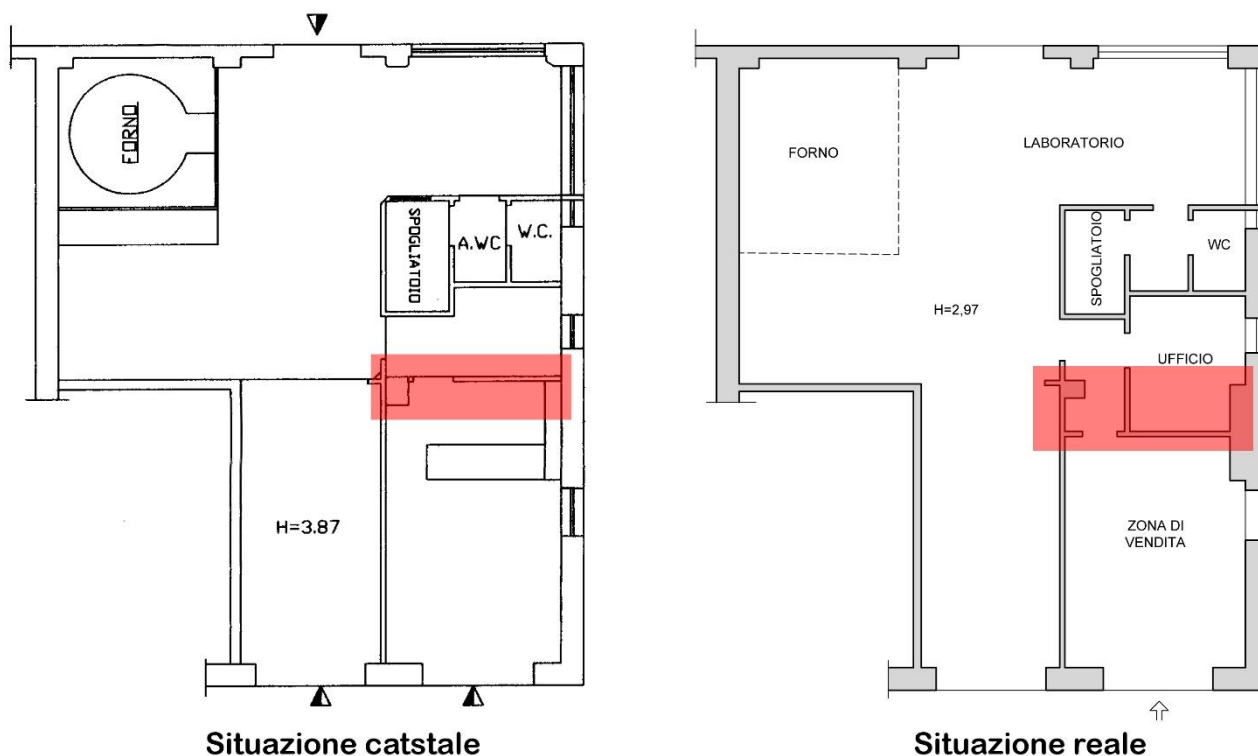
Lotto 1. Piano terra, planimetria catastale.
